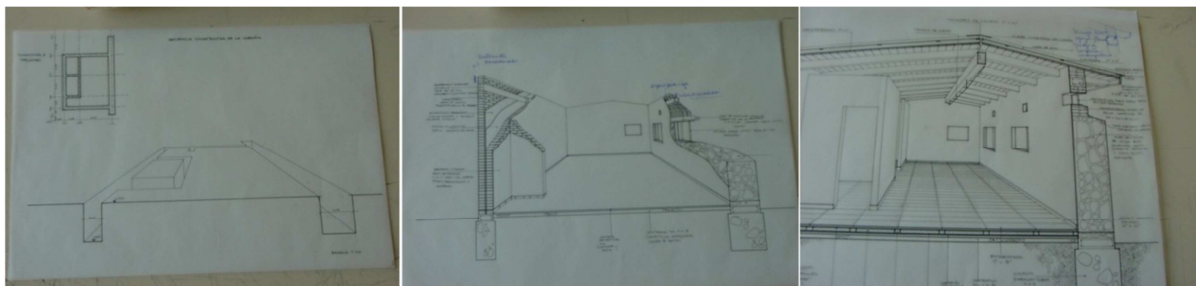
Propuesta para Ischigualasto. Láminas de secuencia constructiva en corte fugado.
